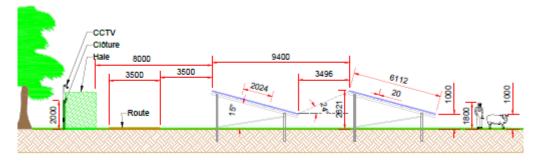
Plan de coupe des structures photovoltaïques avec la piste d'accès
